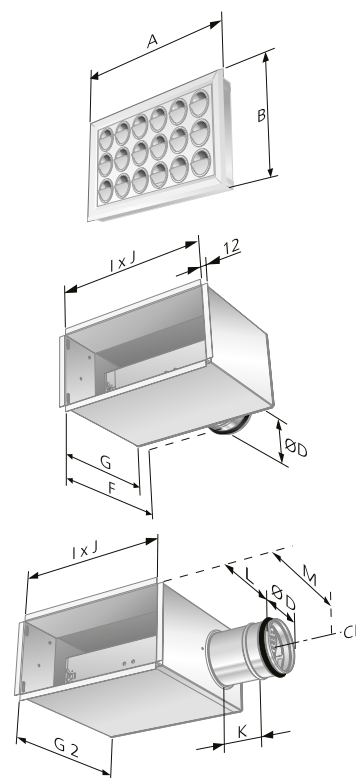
COLIBRI Wall avec plénum d'équilibrage ALV.
